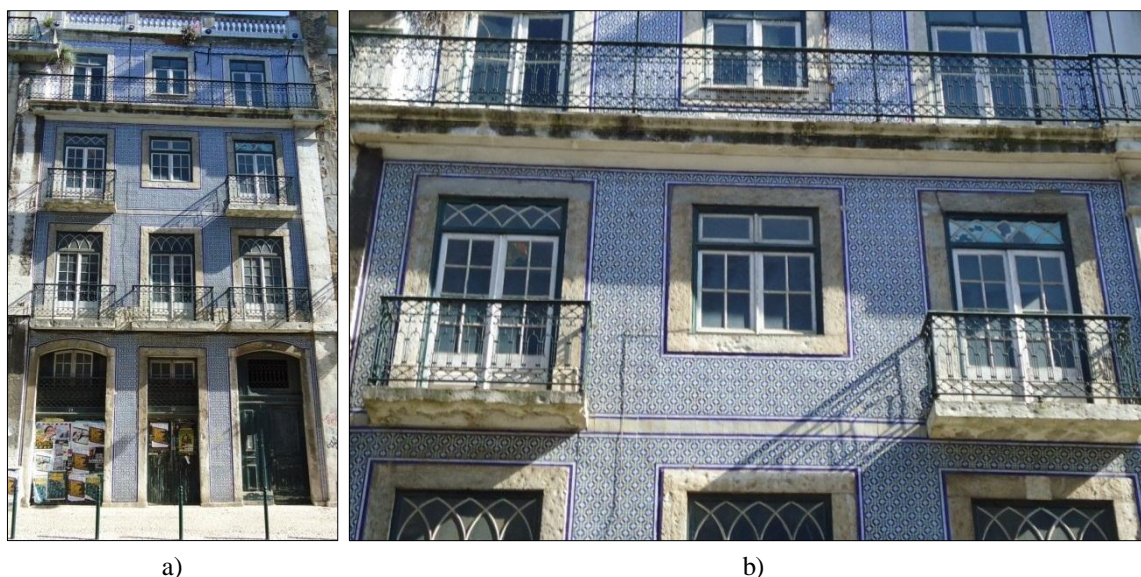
Vista exterior do edifício estudado. a) Fachada principal. b) Janelas de sacada e de peito no mesmo piso.
